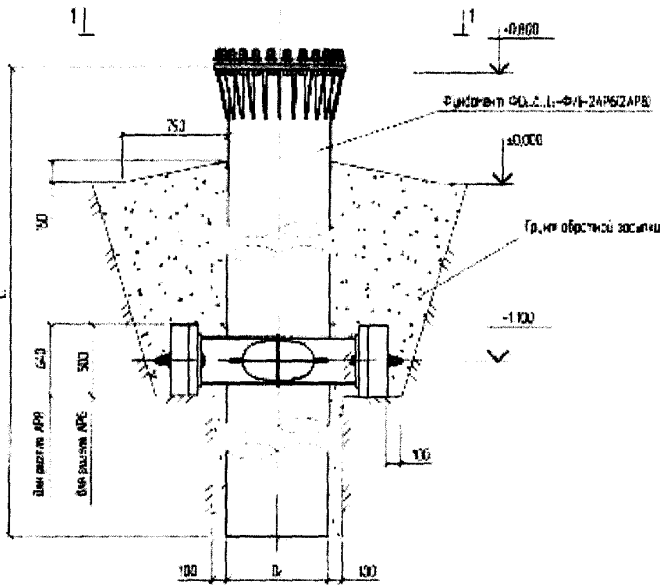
Схема фундамента из сваи-оболочки без ригеля
